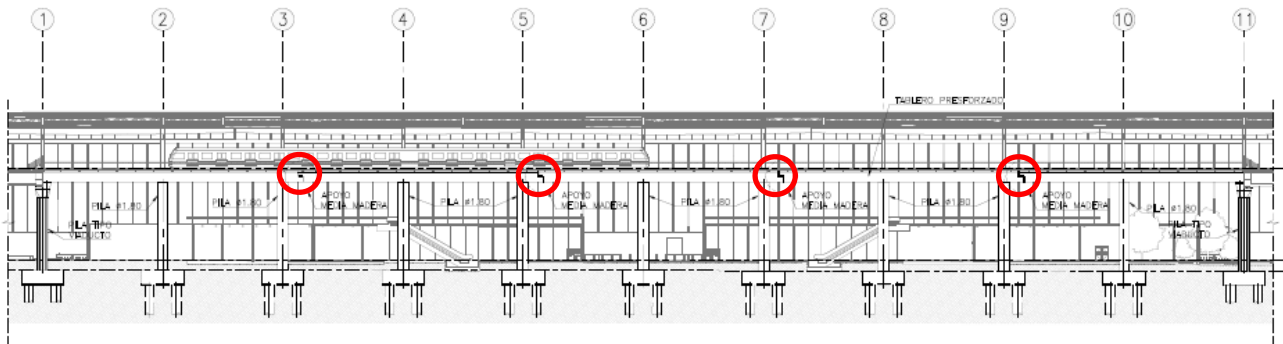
Sección longitudinal de la estación de Zinacantepec.
